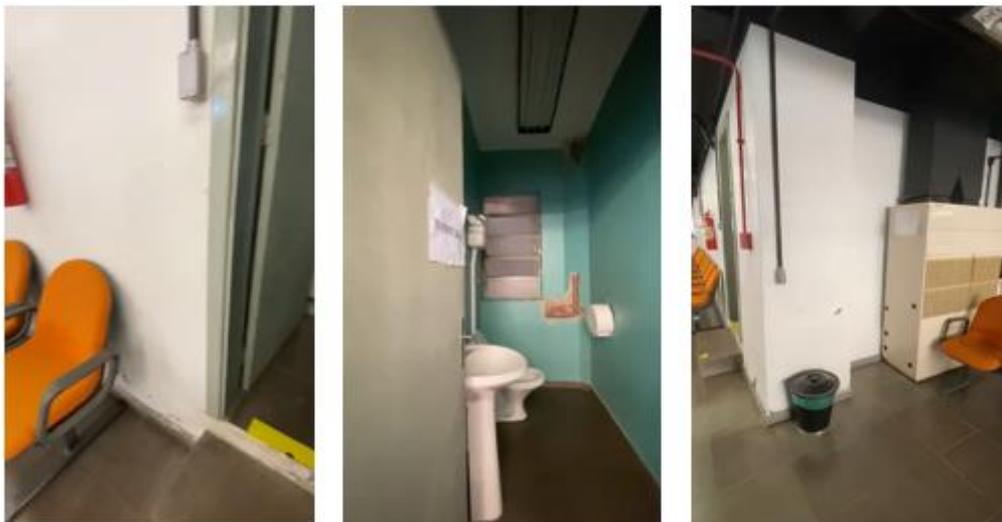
patologias encontradas nas áreas dos sanitários do 2º pavimento, devido ao vazamento ocorrido do shaft do 3º pavimento
